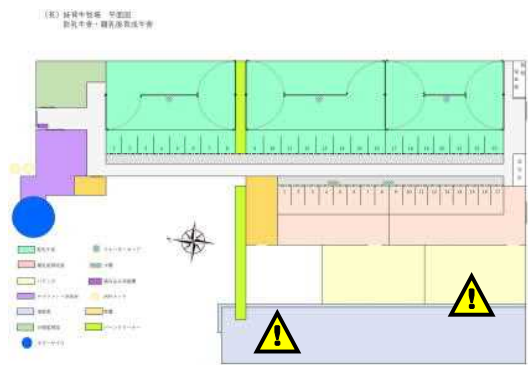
乾乳牛舎の平面図 (⚠ は事故発生並びに危険箇所)
